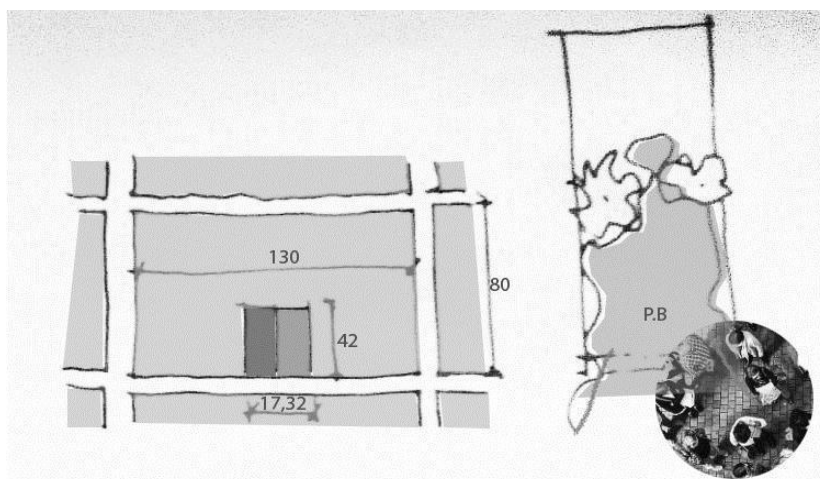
Lotes integrados en la manzana y planta baja como espacio de uso comunitario.
